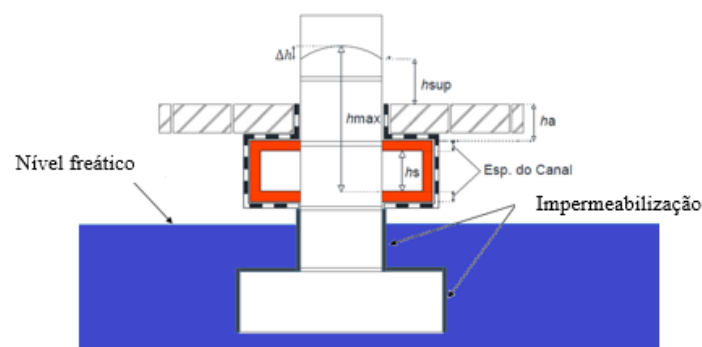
Aplicação de um sistema de ventilação com nível freático acima da fundação da parede
